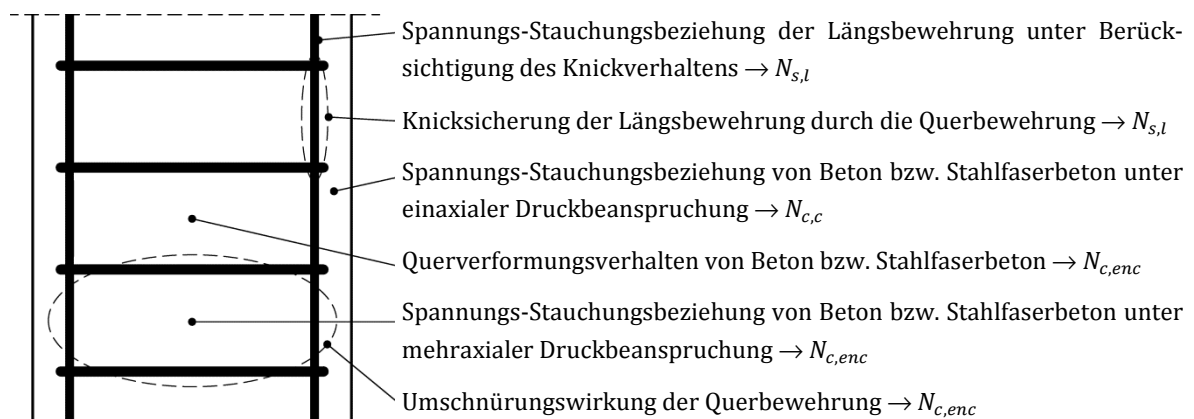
Erforderliche Grundlagen zur Beschreibung des Last-Verformungsverhaltens zentrisch beanspruchter Stahlbetondruckglieder
